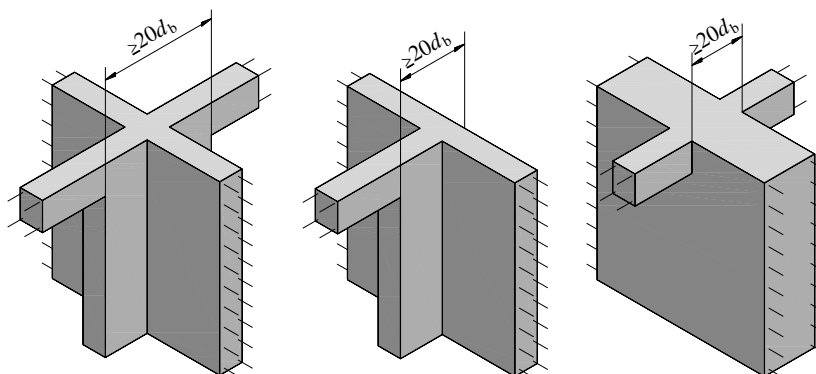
Схемы ортогонального примыкания балок к стенам, соответствующие условию 5.3.2 в)
